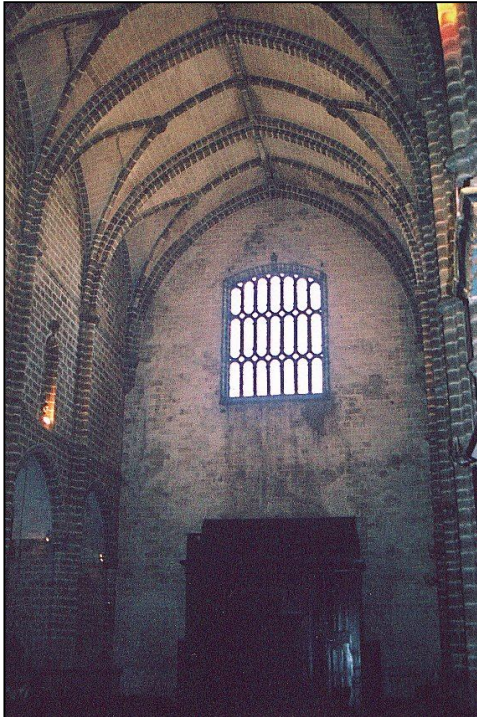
e 33 – Vista das fissuras existentes no interior da fachada principal da Igreja, e que ladeiam o janelão, desta fachada.
